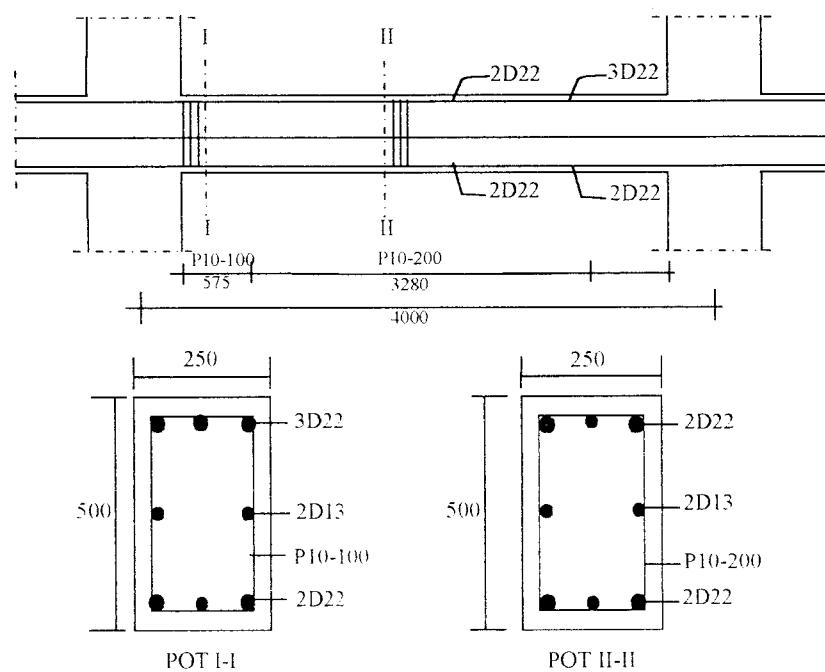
Balok Portal E Bentang 4 m Lantai 10
